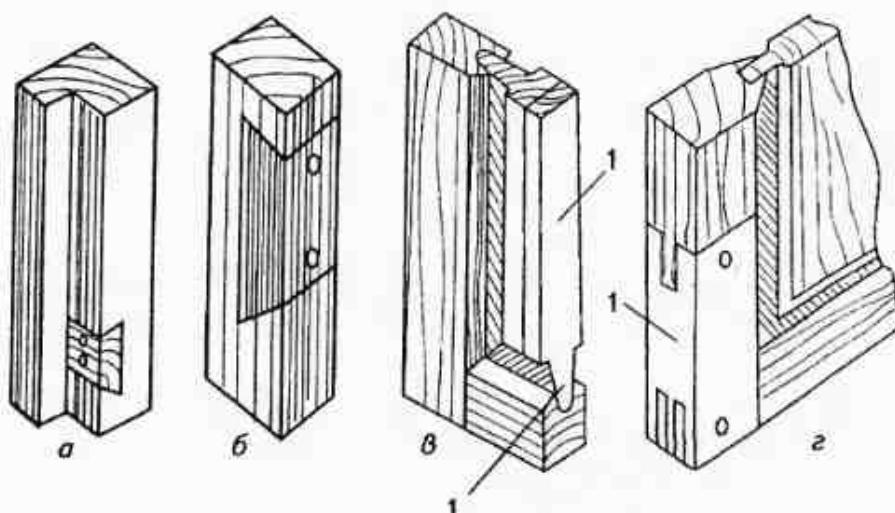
Ремонт дверей и дверных коробок. Вставка новой древесины: а — вставка новой древесины в коробку под петли; б — вставка новой древесины в дверной бруск в месте установки замка; в — ремонт филенки составной вставкой; г — ремонт дверного бруска (1 — вставка)
